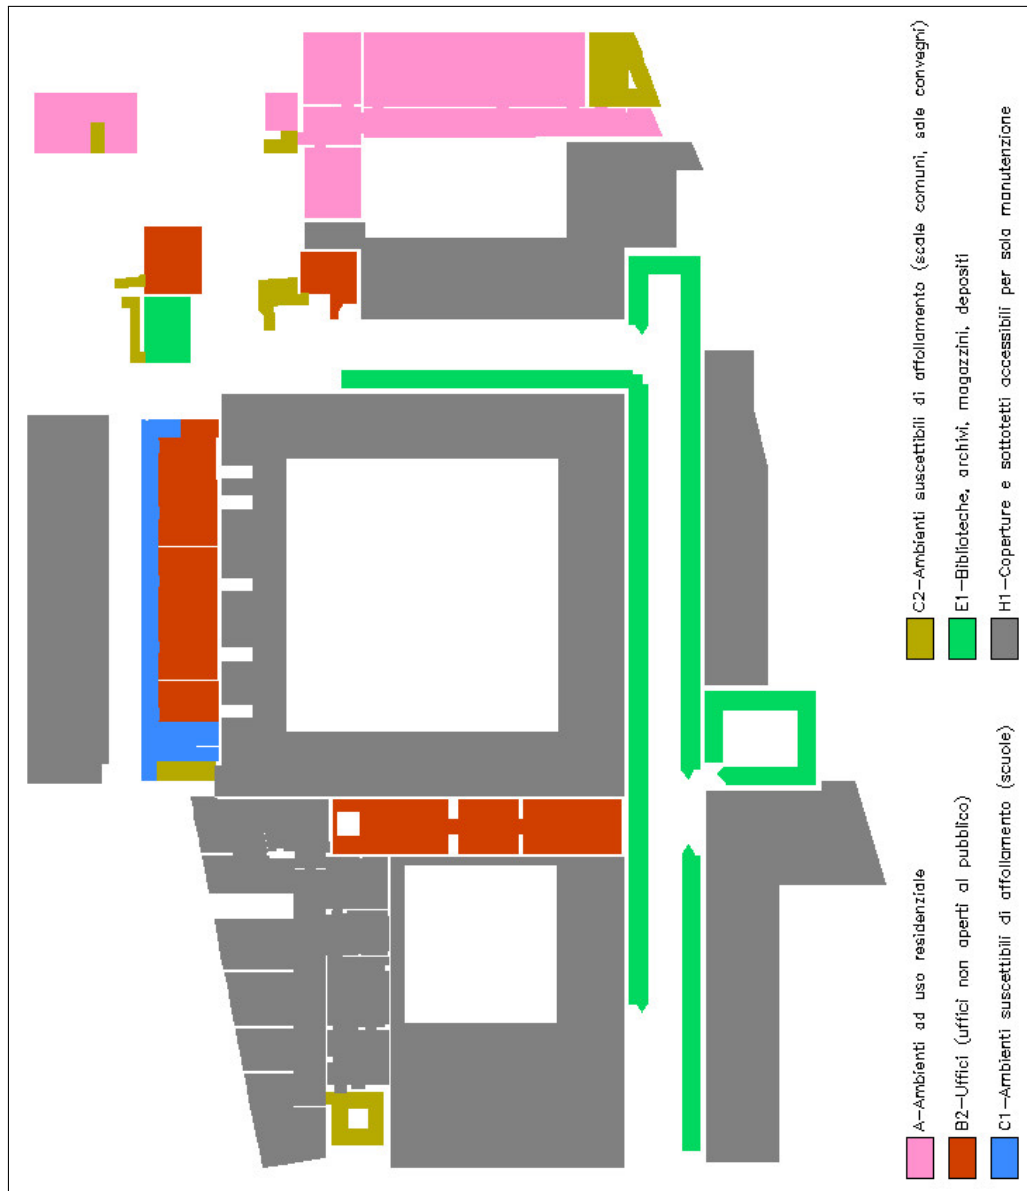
Pianta piano terzo. Carichi divisi per ambiente.
